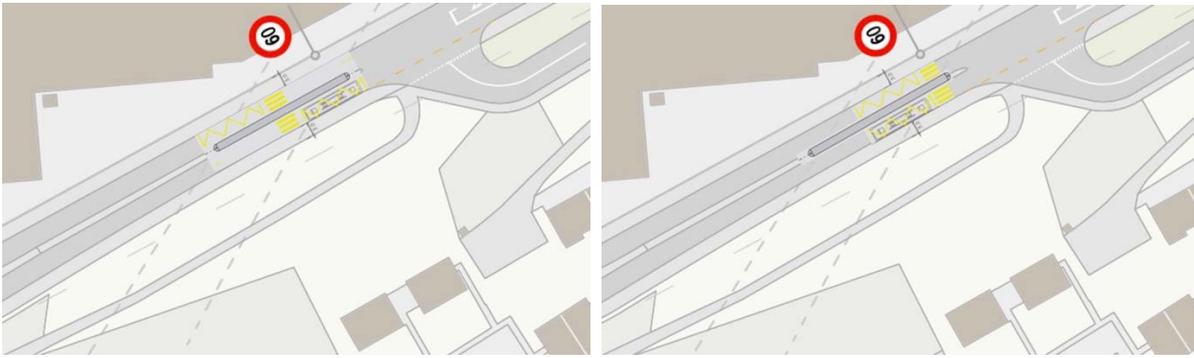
Verlegung Haltestelle Arova: Varianten nördlich Einmündung Neustrasse
